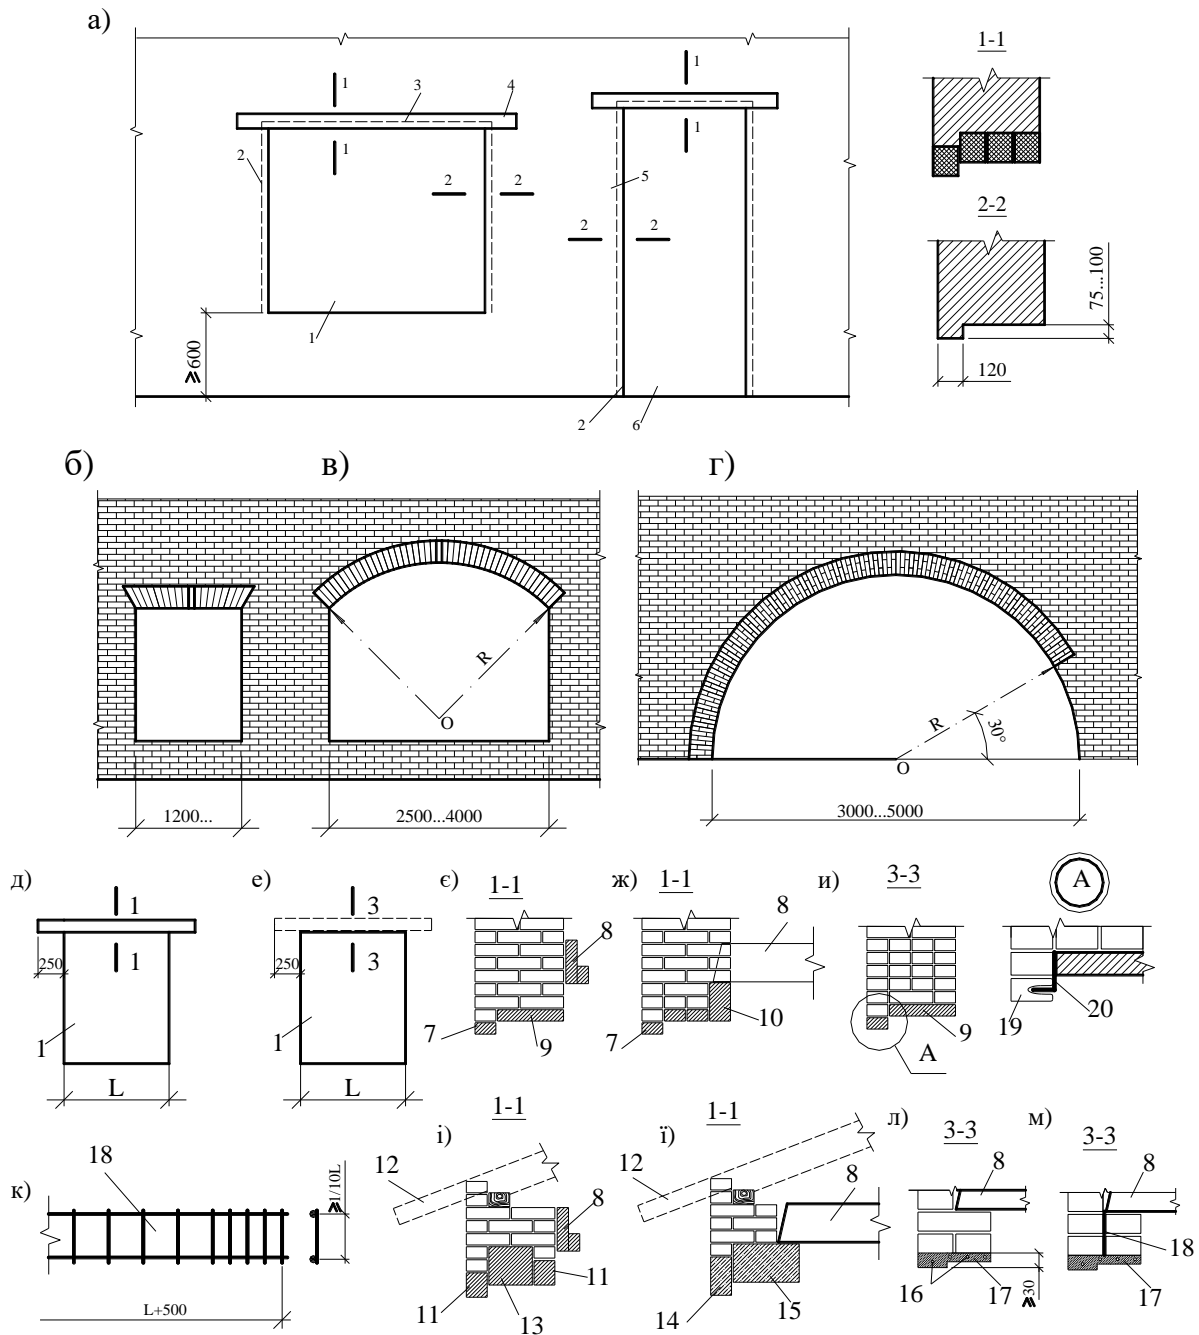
Деталі прорізів у стінах: а – схеми прорізів; б – клинчаста плоска (пряма) перемичка; в – аркова перемичка; г – напівциркульна; д – брускова або плитна; е – те саме з рядовою армокам'яною чи з декоративним каменем; є – збірні залізобетонні перемички в самонесучій стіні; ж, і, ї – те саме в несучій стіні; и – залізобетонна перемичка із сталевим кутиком і декоративним каменем; к – арматурний каркас; л – рядова перемичка; м – армокам'яна перемичка; 1 – віконний проріз; 2 – бокова лутка; 3 – чвертка; 4 – перемичка; 5 – простінок; 6 – дверний проріз; 7 – брускова перемичка (65×120 мм); 8 – елемент перекриття; 9 – плитна перемичка (65×380 мм); 10 – брускова підсилена перемичка (120×120 мм); 11 – брускова перемичка (120×140 мм); 12 – дах; 13 – брускова підсилена перемичка (250×220 мм); 14 – те саме (120×220 мм); 15 – плитна перемичка (220×380 мм); 16 – арматура $\varnothing 6$ мм або штабова сталь; 17 – дрібнозернистий бетон; 18 – арматурний каркас; 19 – декоративна цегла з пазом; 20 – сталевий кутик
